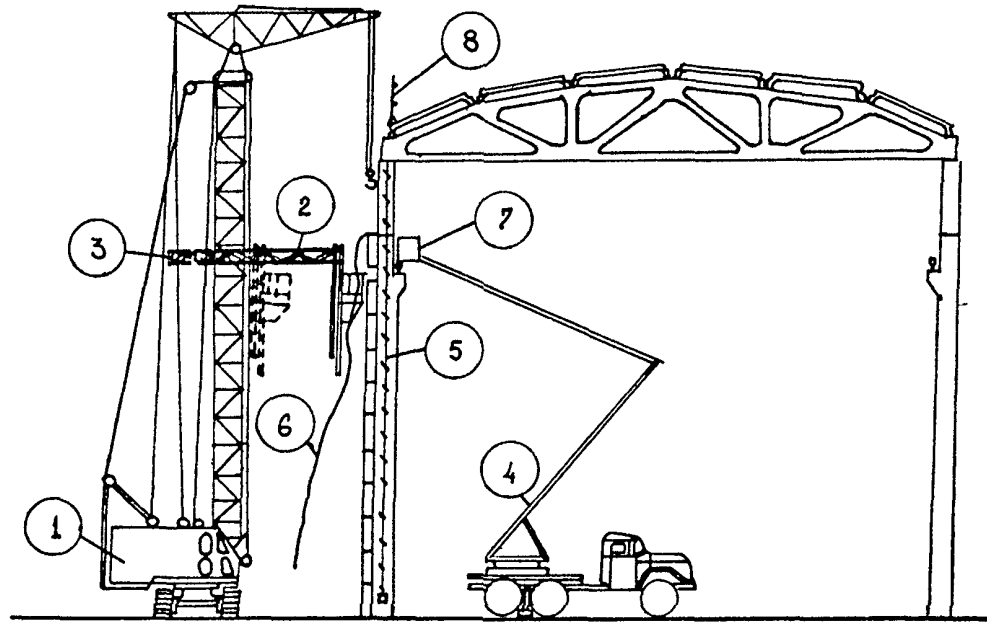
Монтаж стеновых панелей одноэтажных промышленных зданий с использованием средств безопасности
